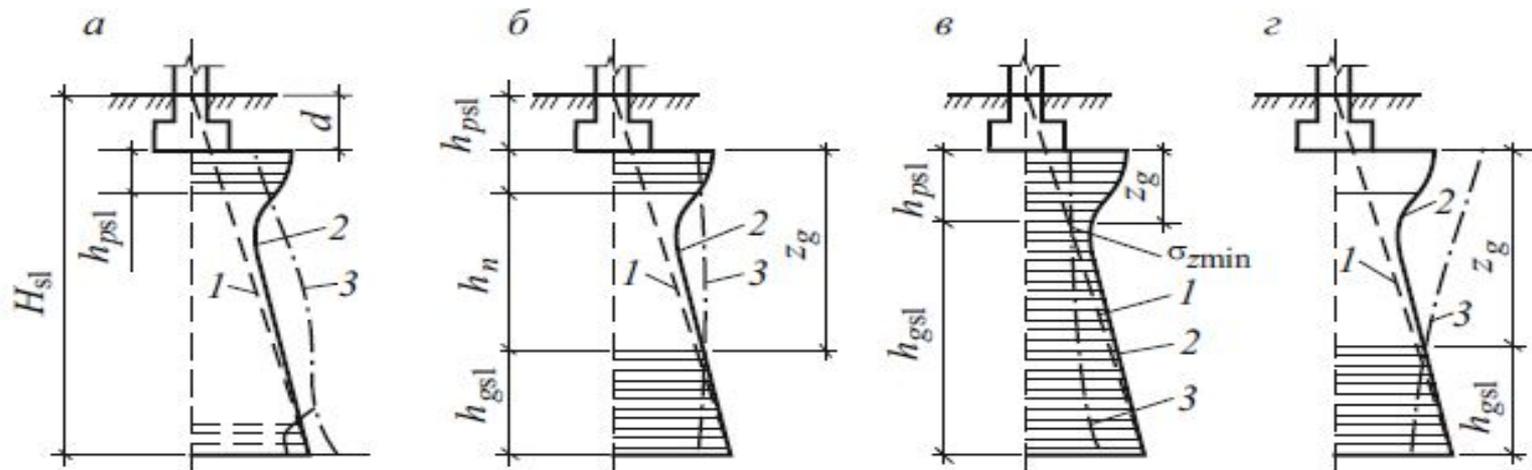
Схемы к расчету просадок основания: а – I тип грунтовых условий; б, в, г – II тип грунтовых условий; 1 – эпюра вертикальных напряжений от собственного веса грунта σ_{zg} ; 2 – эпюра суммарных вертикальных напряжений от внешней нагрузки и собственного веса грунта $\sigma_z + \sigma_{zg} + \sigma_{zp}$; 3 – изменение с глубиной начального просадочного давления p_{sl} ; H_{sl} – толщина слоя просадочных грунтов
